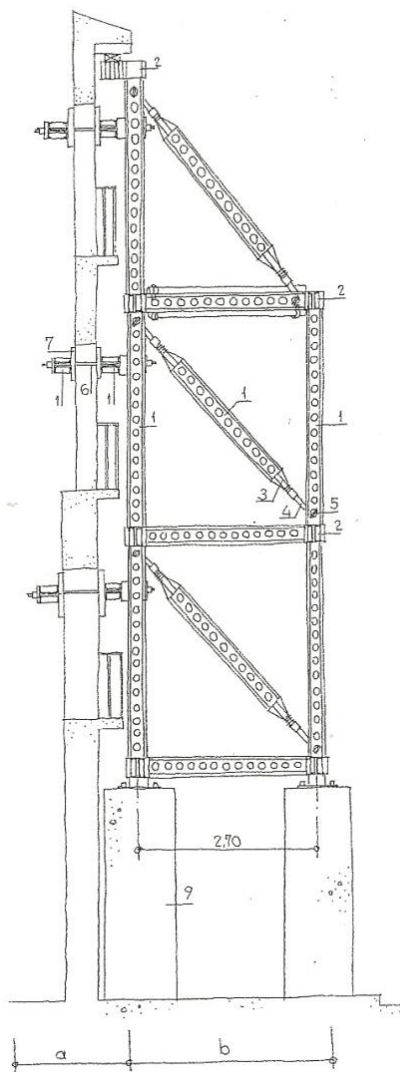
g. Estructura estabilizadora de fachada en sistema soldier.
